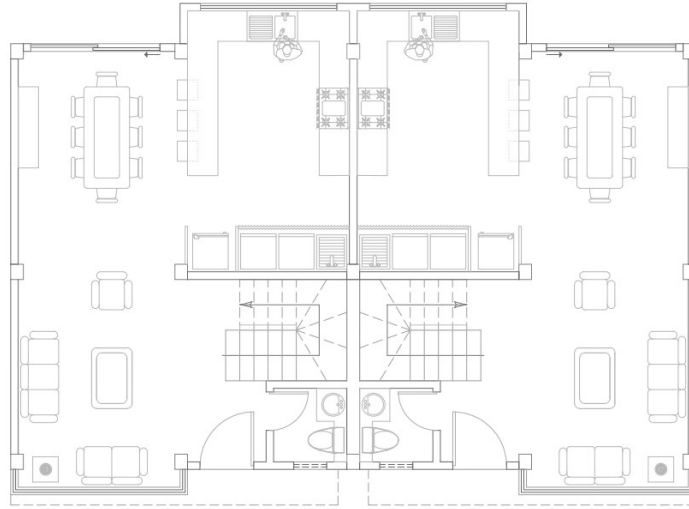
Planta baja de las casas del conjunto Rosé, distribución interior de un bloque de casas
